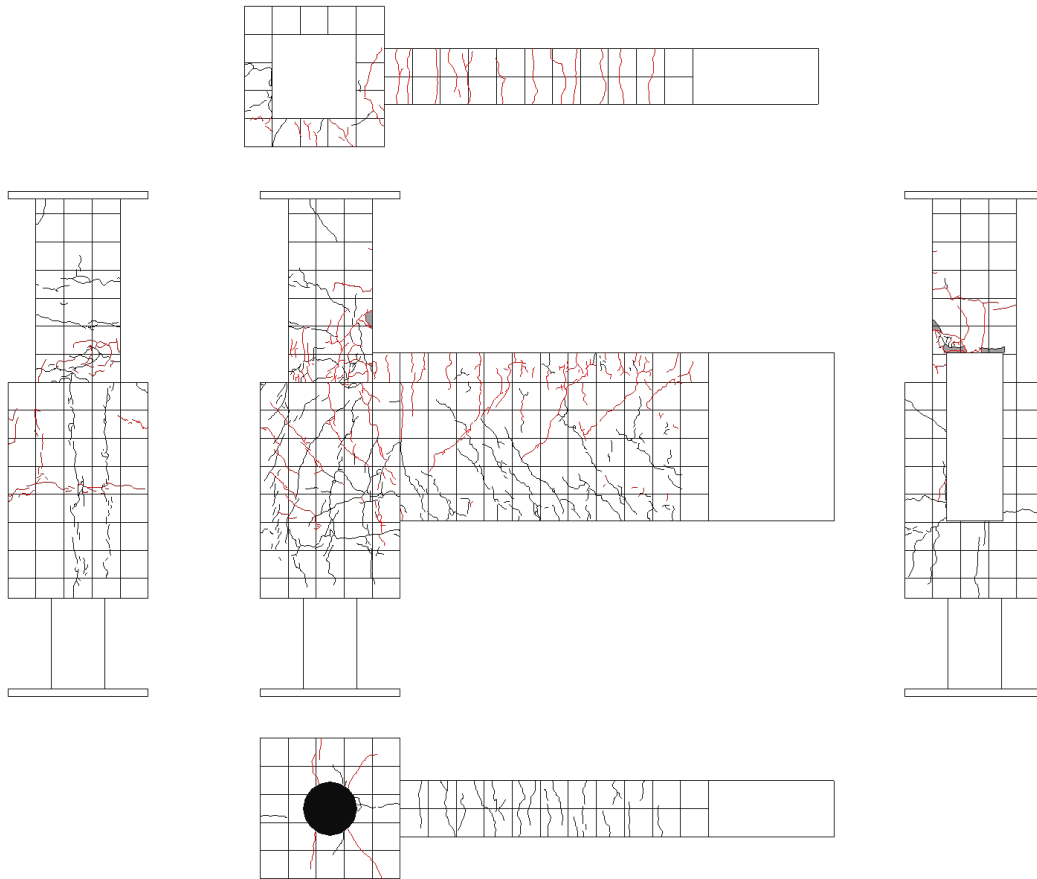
試験体 A-7a ひび割れ状況 (6Cycle)
